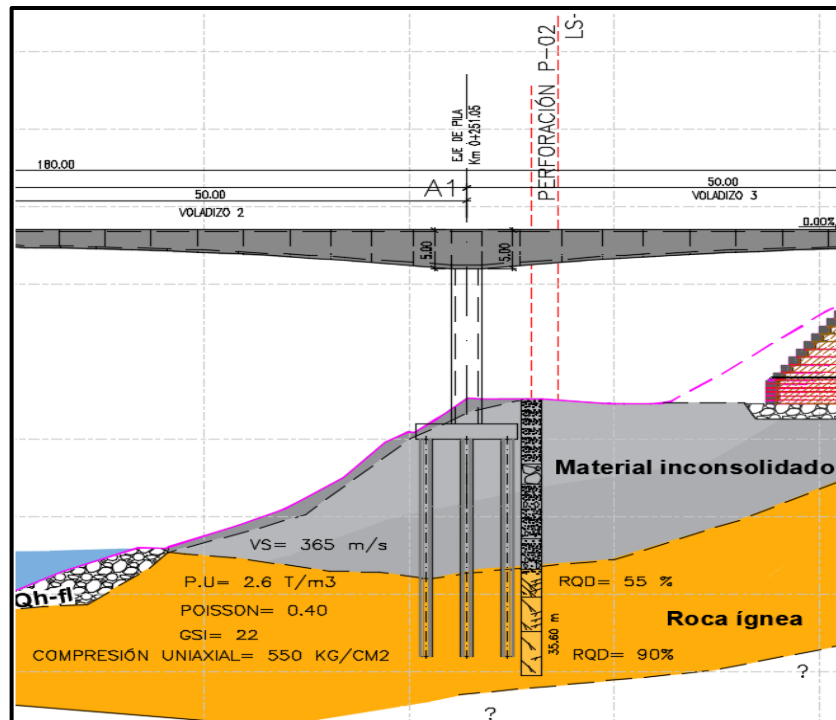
Parámetros geotécnicos de la zona de emplazamiento del apoyo A1.
